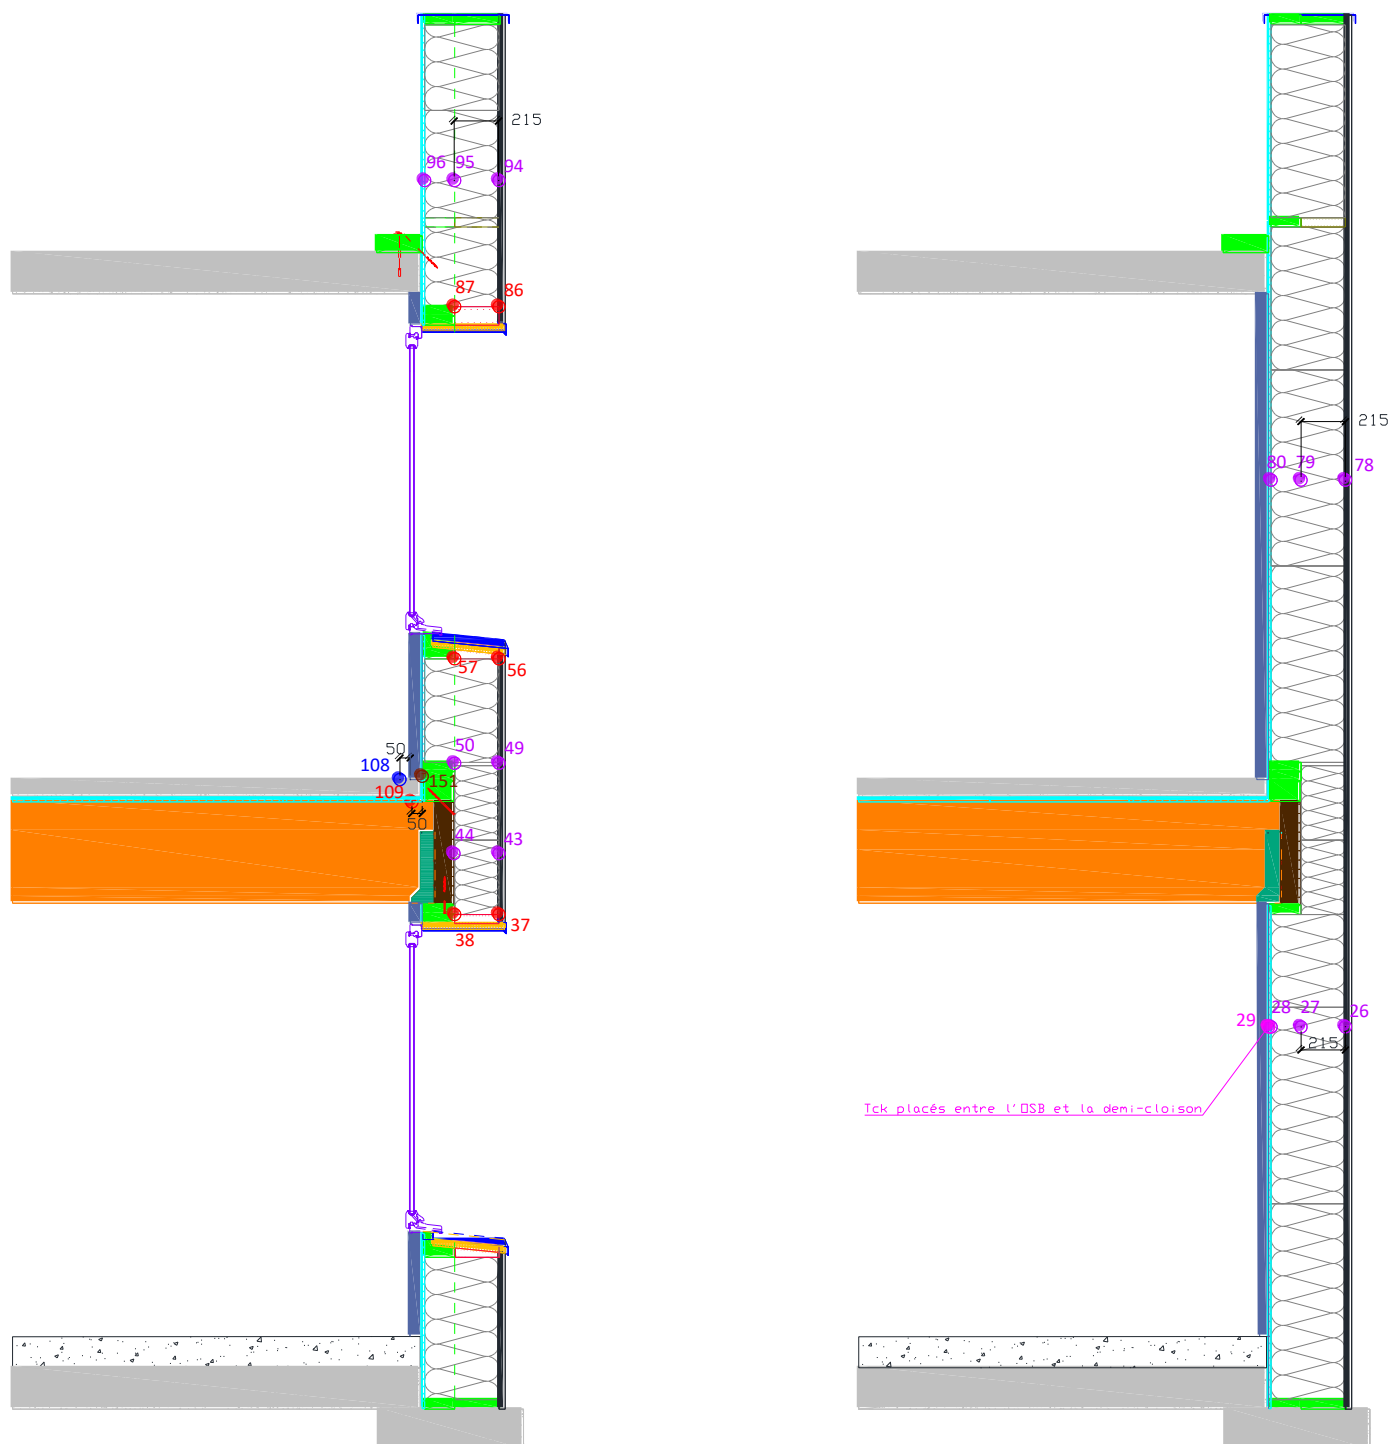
Instrumentation de l'élément de façade - (A gauche) : Coupe G-G - (A droite) : Coupe H-H
